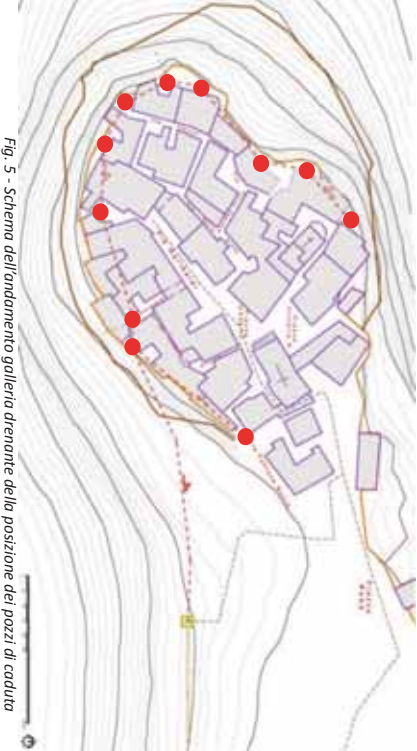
Schema dell'andamento galleria drenante della posizione dei pozzi di caduta
